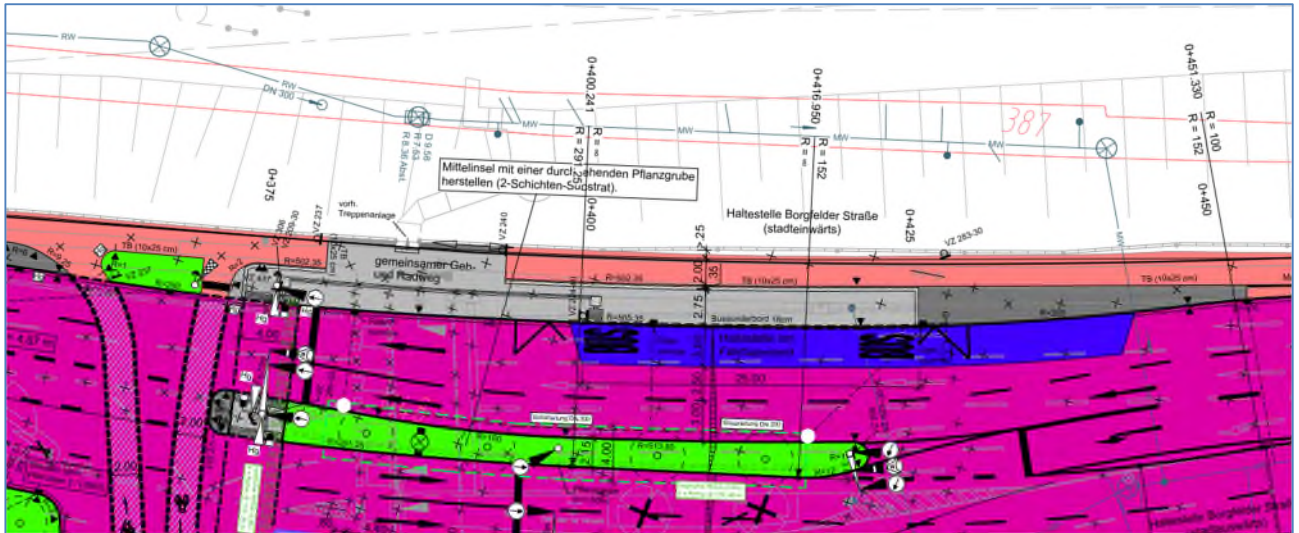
Lageplanausschnitt schlussverschickte Planung 18.06.2024
